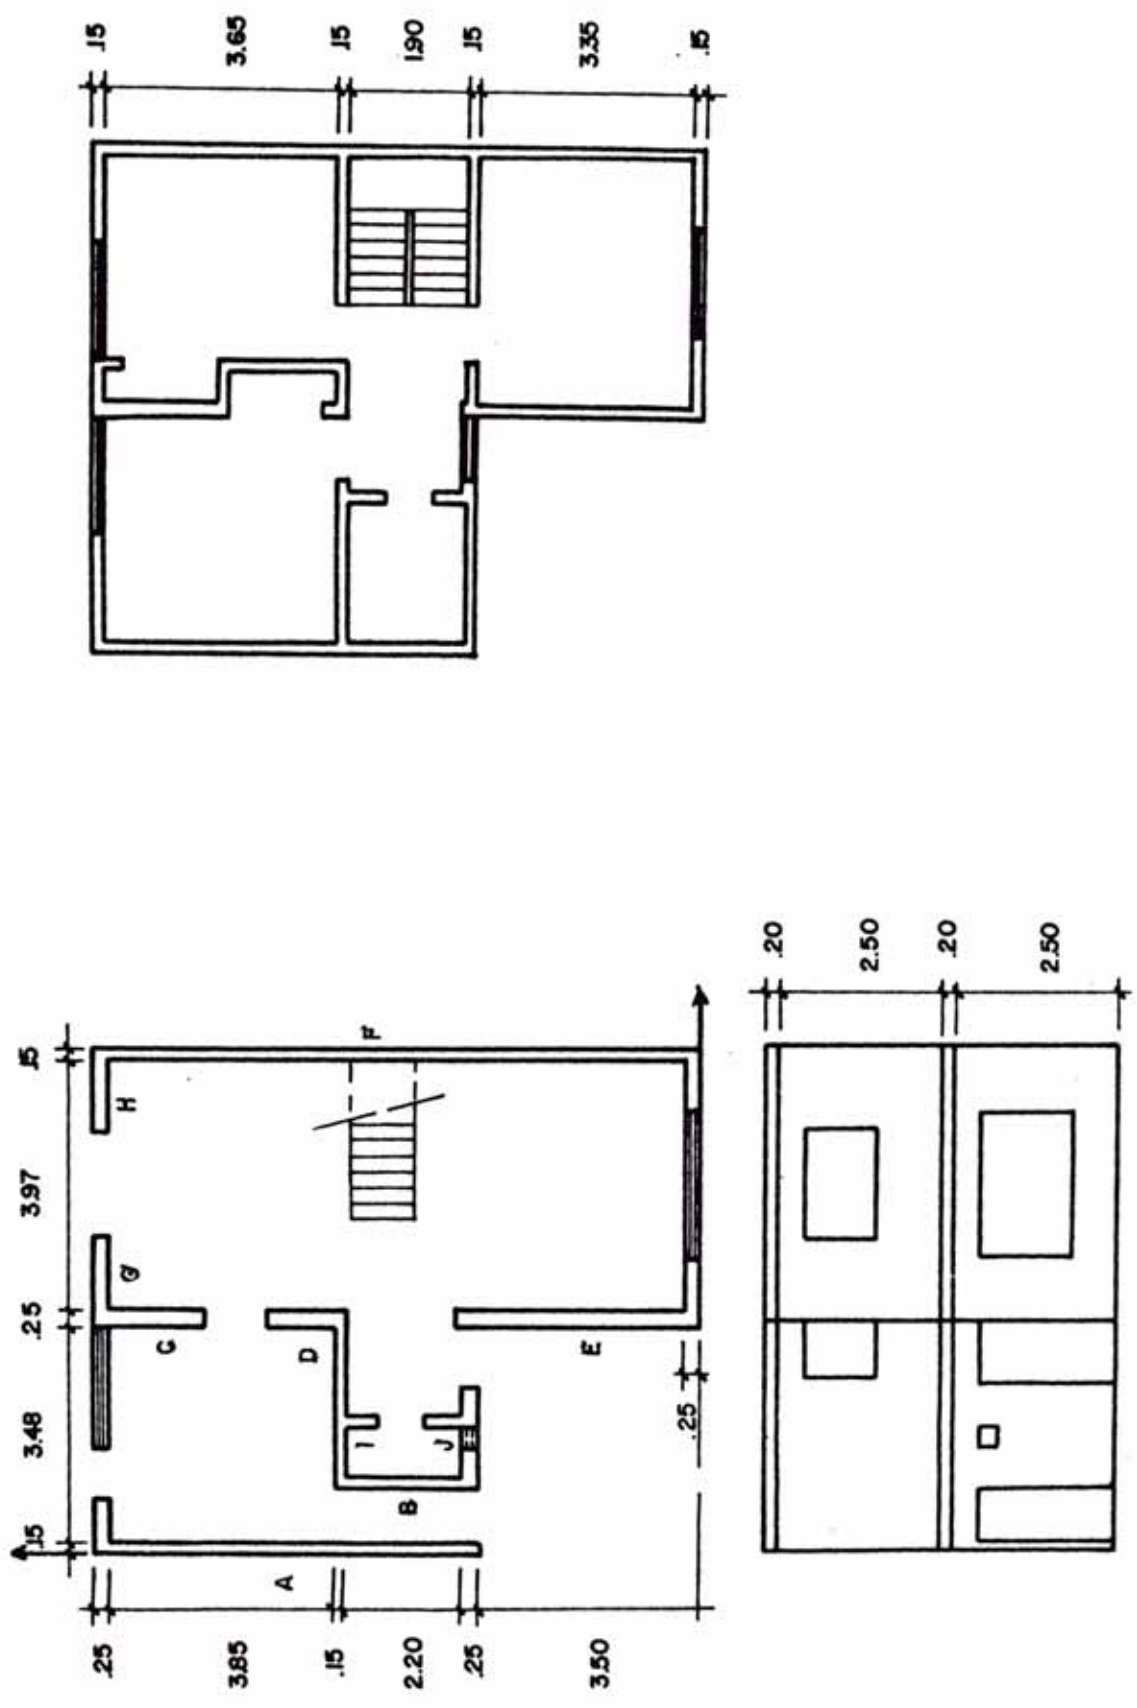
Casa tipo 9, Banco de la Nación, Urb. Buenos Aires, Chimbote (Ref. 9)
